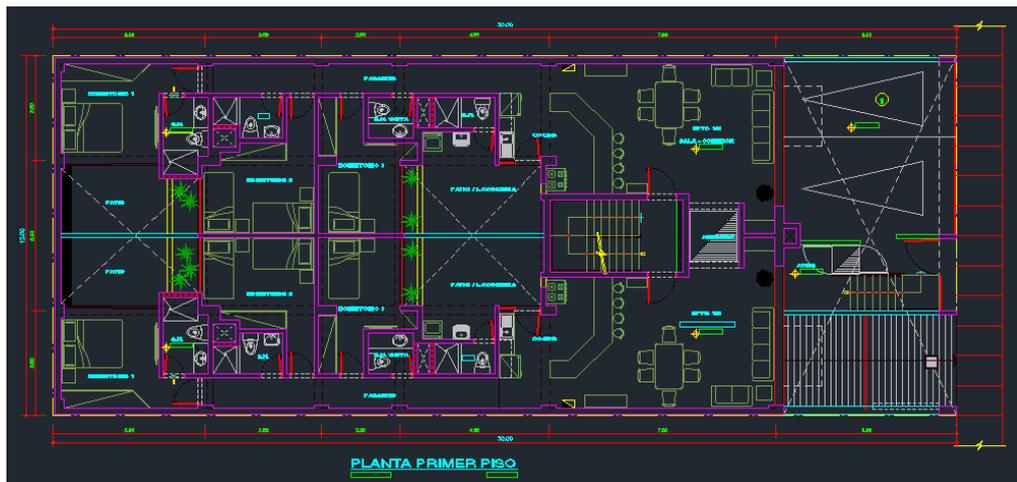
Plano de planta primer piso Edificio Spuknit - Surco
